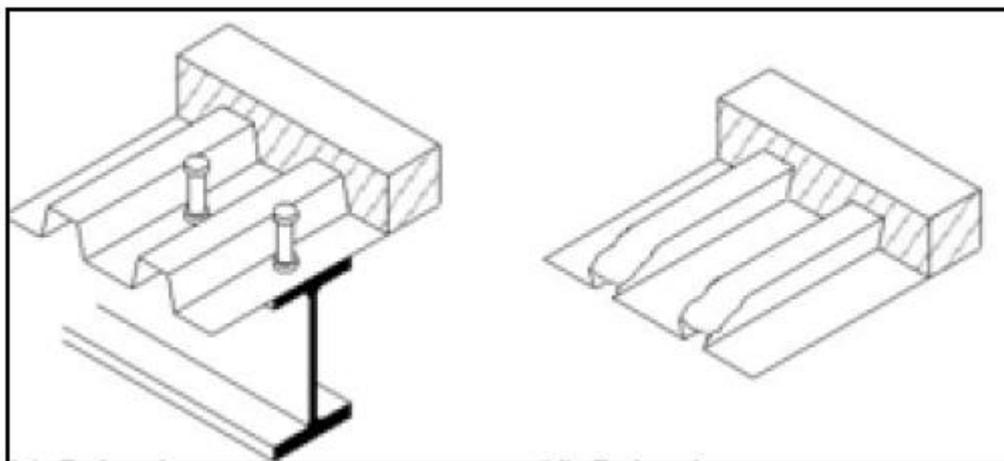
Dalle mixte à base de tôle profil en acier.
